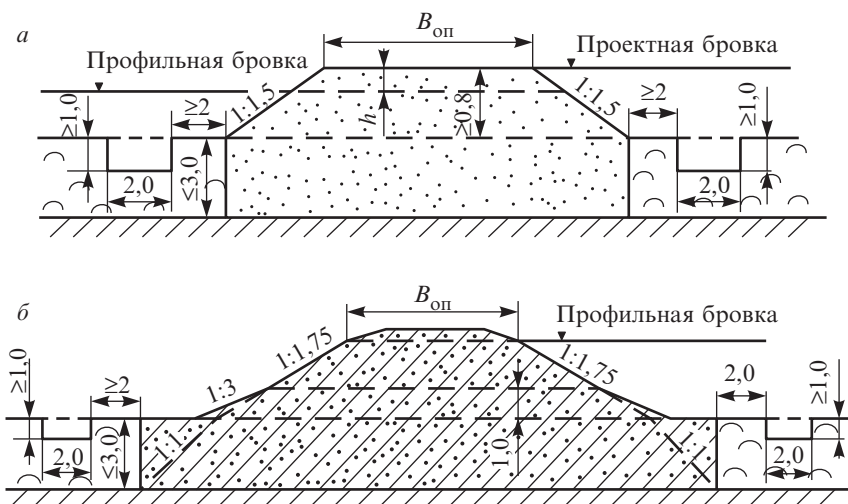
Поперечные профили насыпей на болотах II типа глубиной до 3 м при поперечном уклоне основания не круче 1:1,5:
